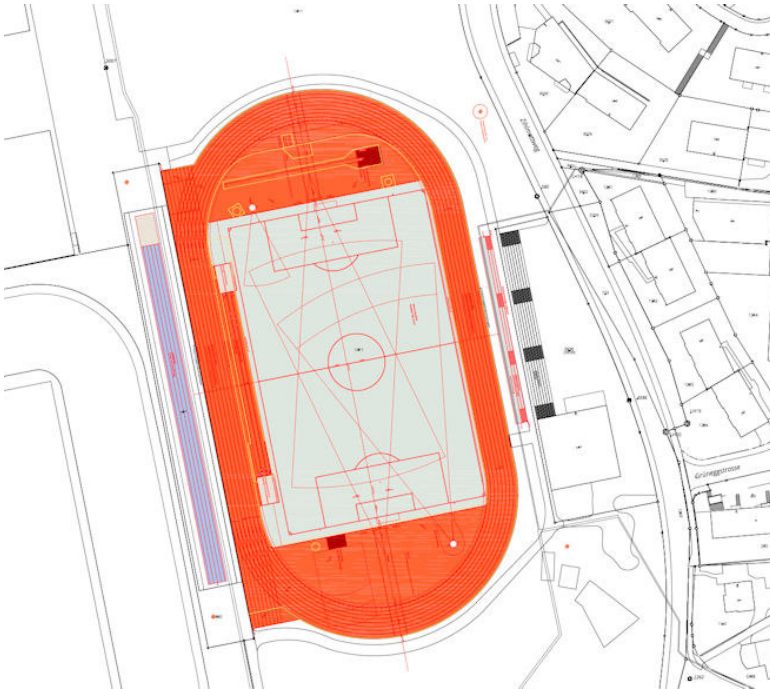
Grundriss Leichtathletikstadion Allmend mit Gebäude des Anwohners
